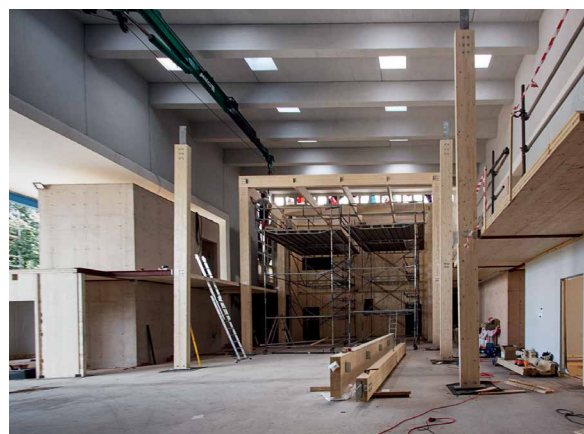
PI-Träger-Decke mit ausgeschnittenen Oberlichtern
